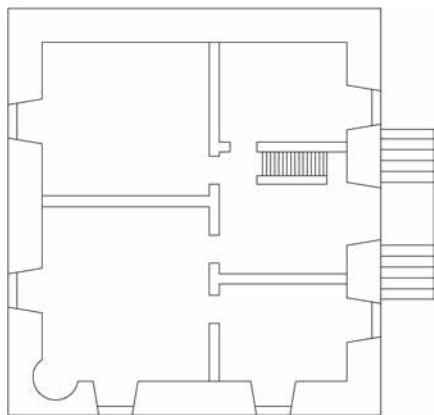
Grundriss des Kanzleigebäudes, Erdgeschoss<sup>73</sup>
